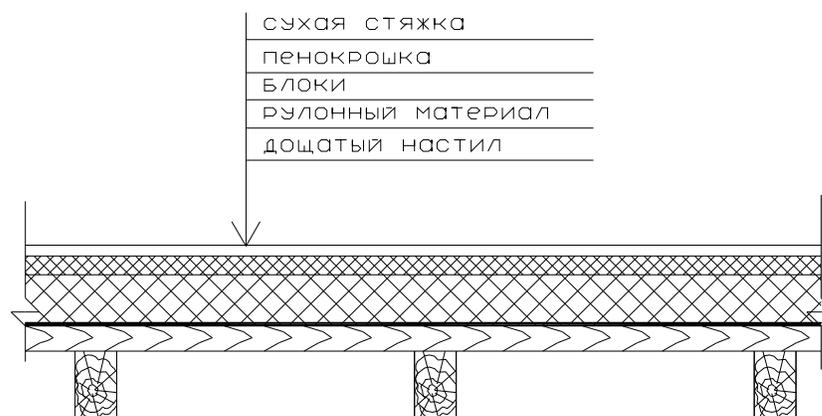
Тепловая изоляция дощатого чердачного перекрытия
